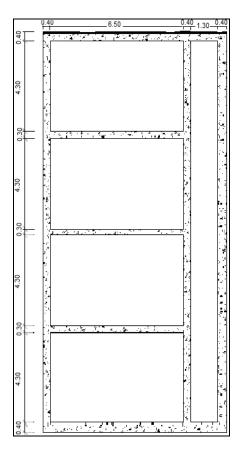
Vista en planta y elevación de estribo del Puente Norte 1.
